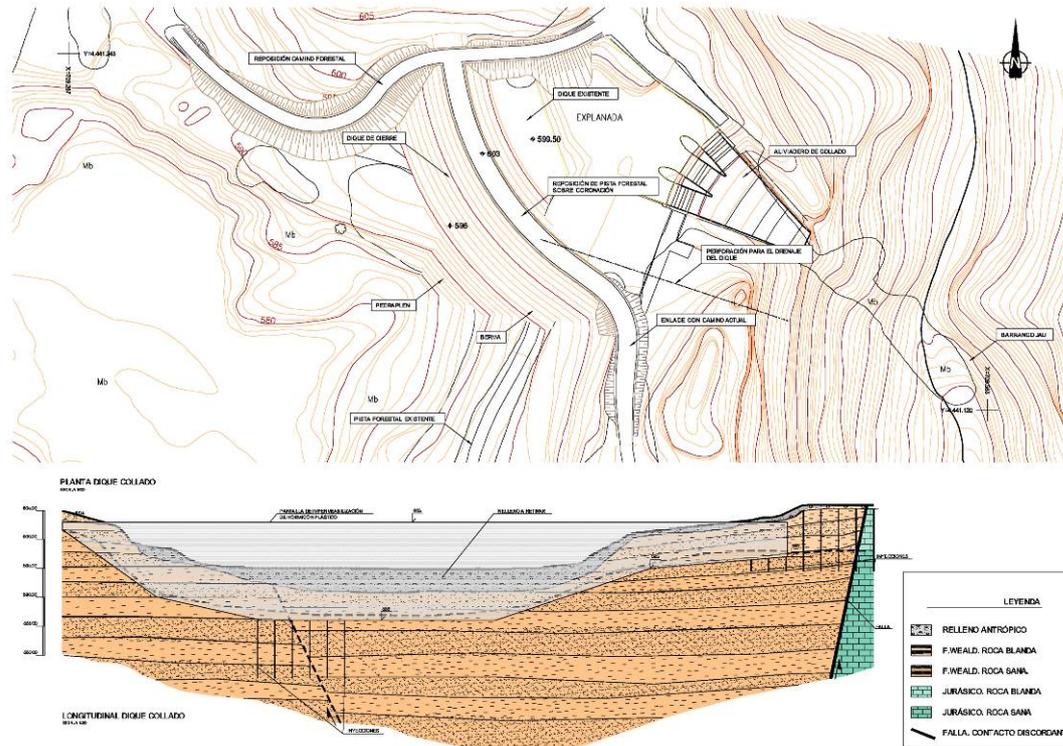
Planta y perfil longitudinal del dique de cierre de collado
